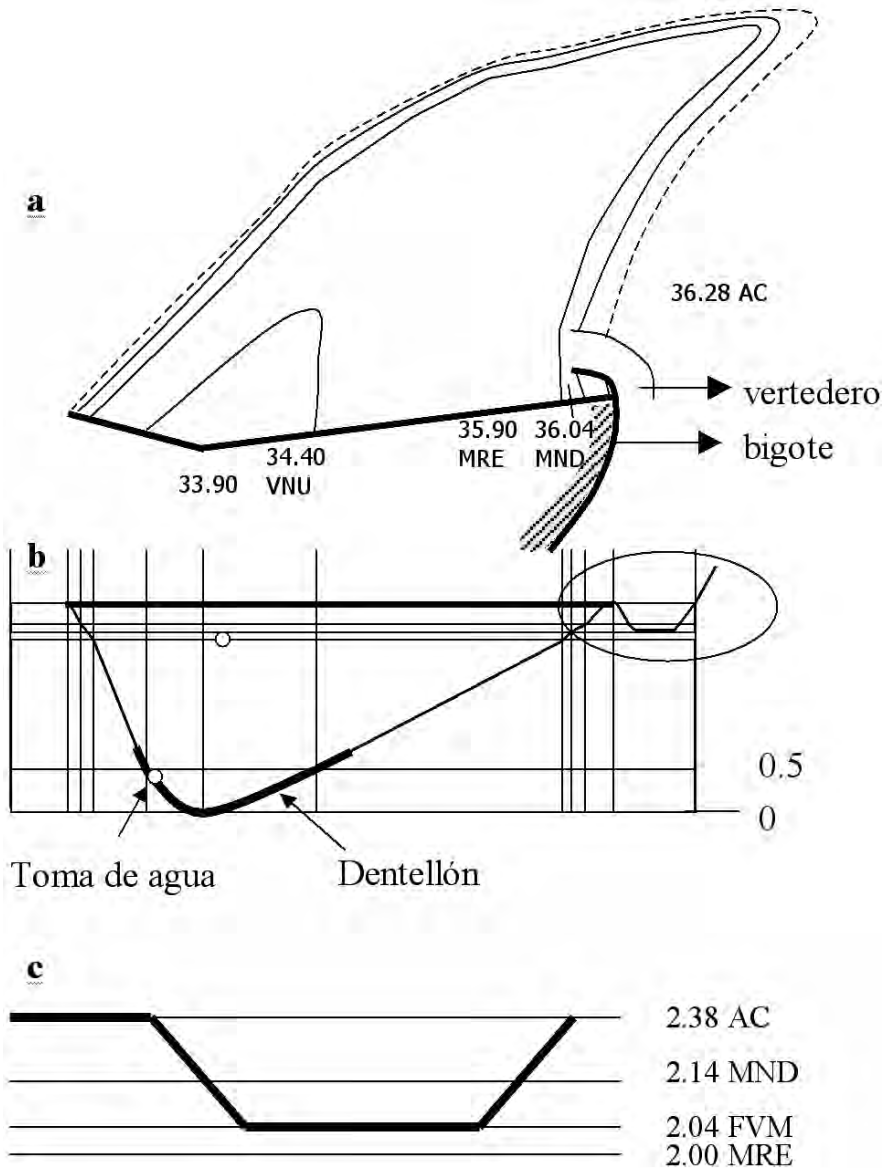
a. Vista en planta del lago y el eje de la cortina, b. perfil longitudinal de la cortina y c. detalle del vertedero.
